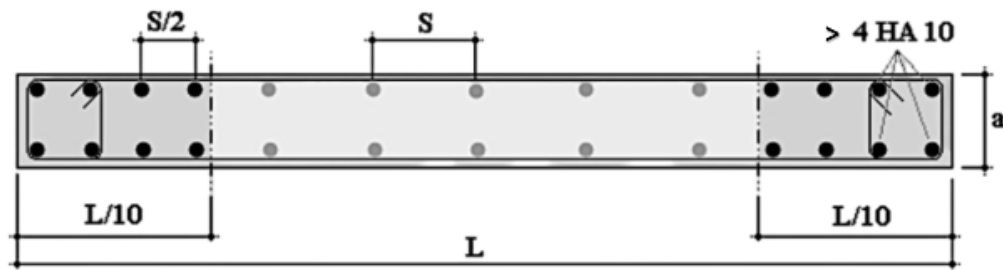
Disposition verticale des armatures dans les voiles
